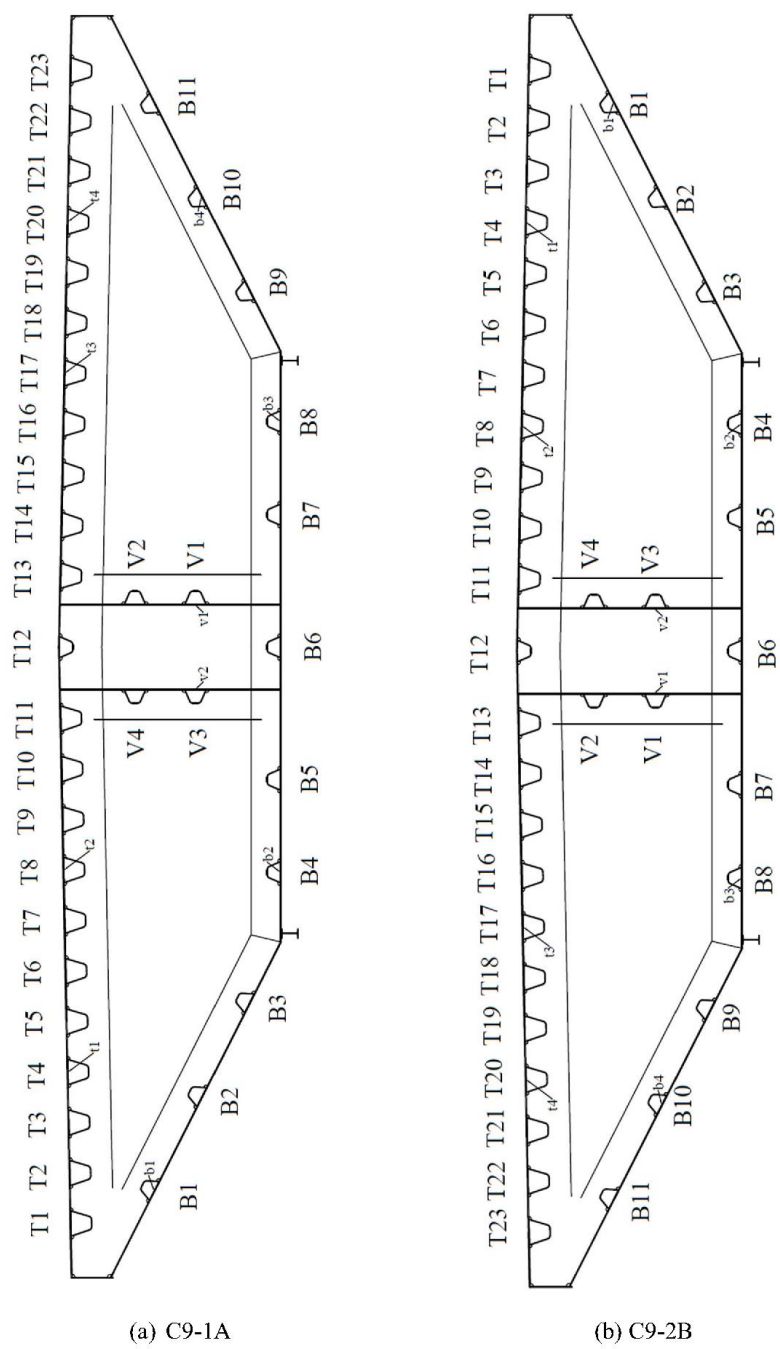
C9-1A 與 C9-2B 斷面 U 型加勁板間梁橋板厚度量測位置(單位: mm)
